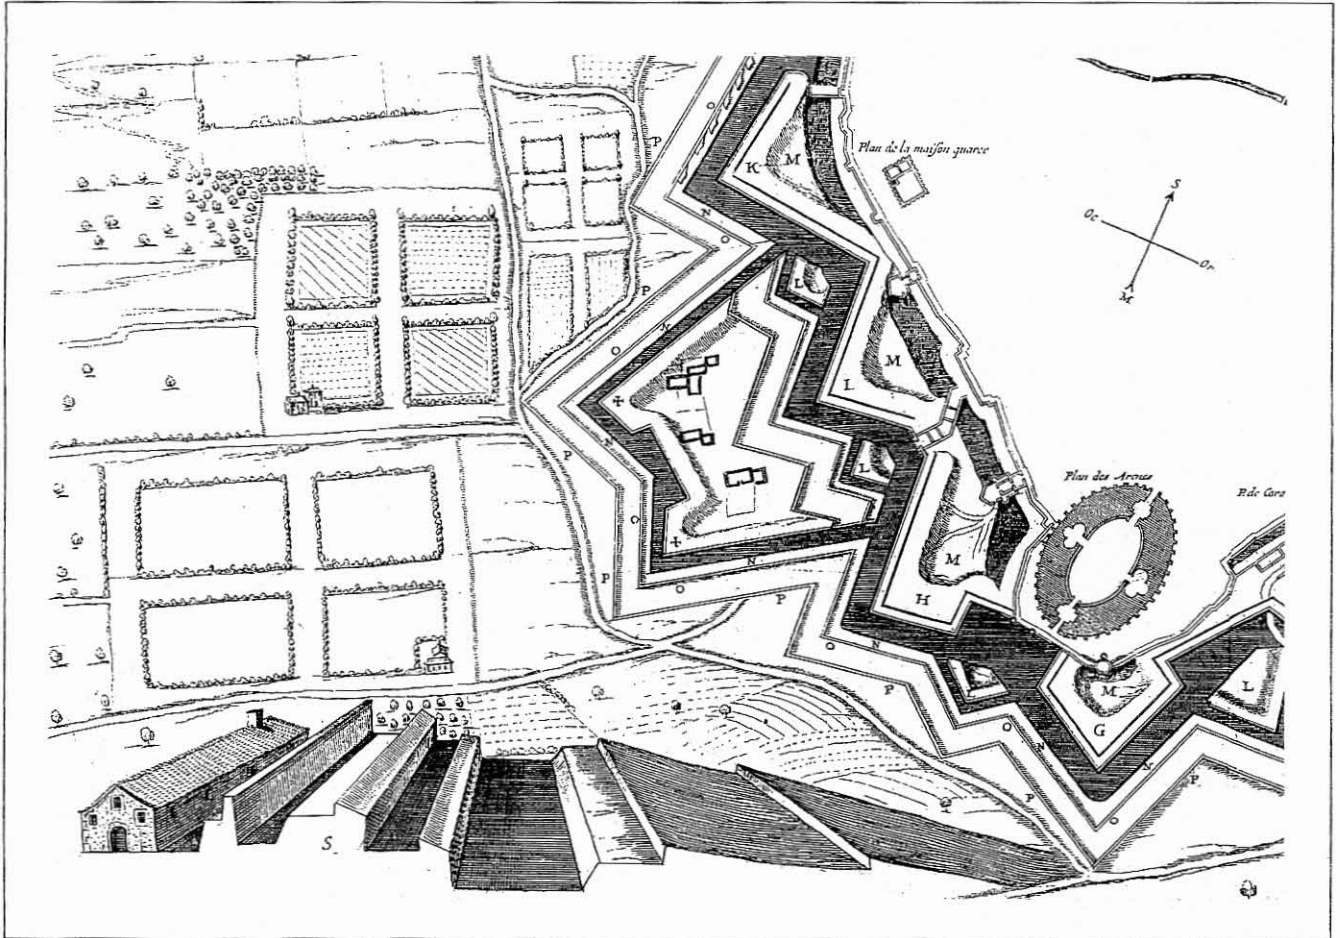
Profil du système défensif (extrait du plan de 1629).
